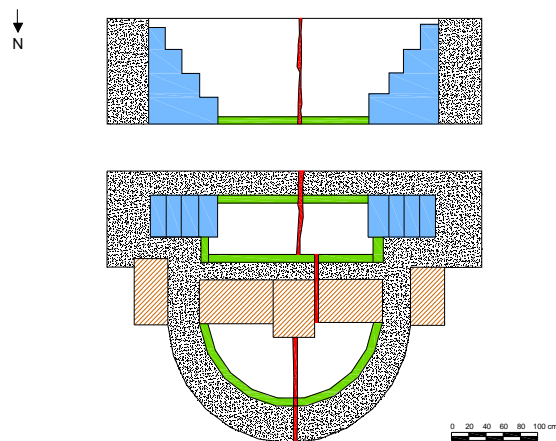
Planta y sección de la estructura hidráulica del Convento de la Merced (a partir de HIDALGO; VENTURA, 2001, 251).
